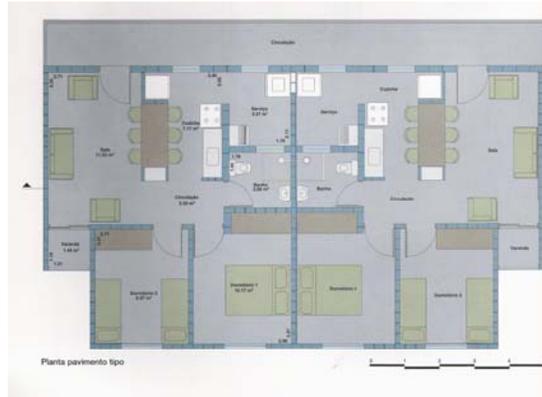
Tipologia planta baixa, Conj. Hab. São Luiz.
